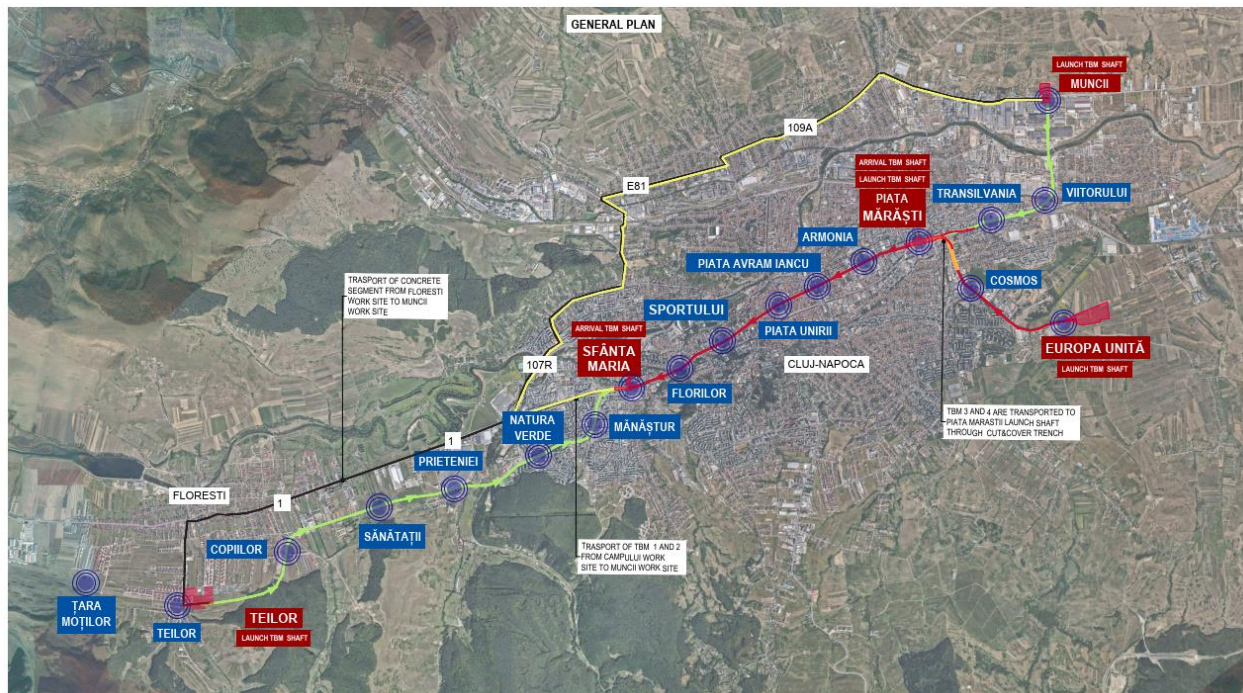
Plan general pentru amplasarea organizărilor de șantier
